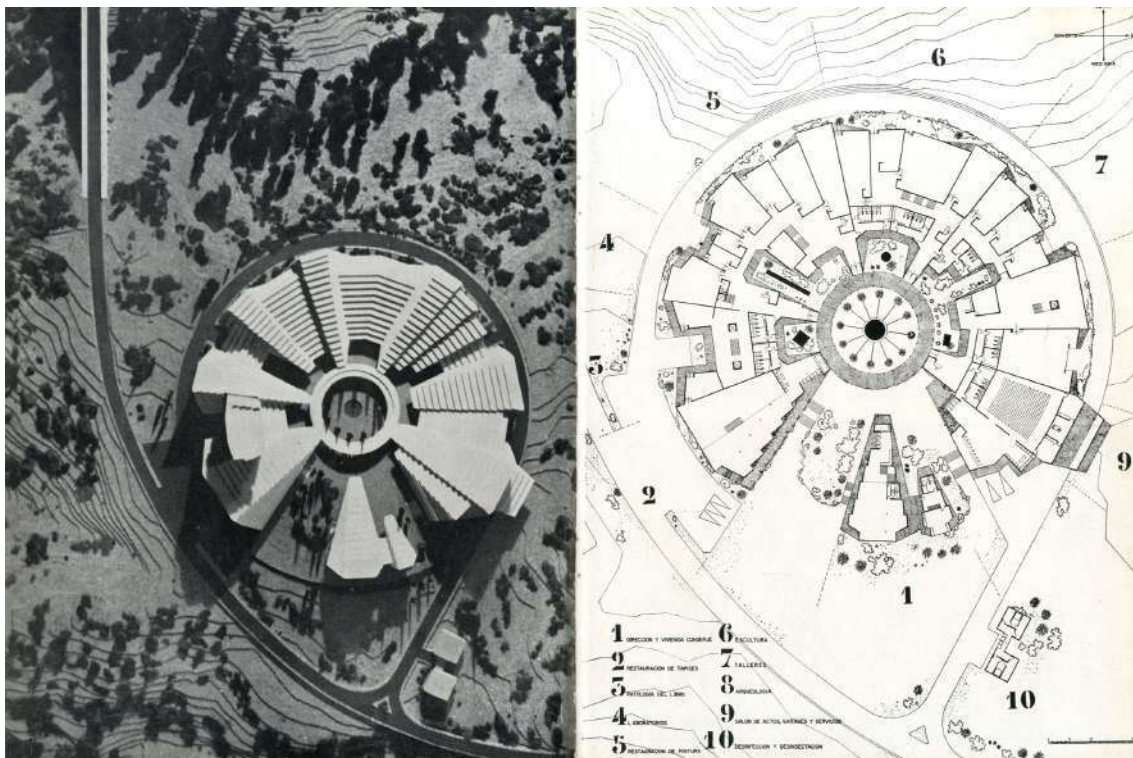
y 3: Maqueta y planta del concurso de 1961.
